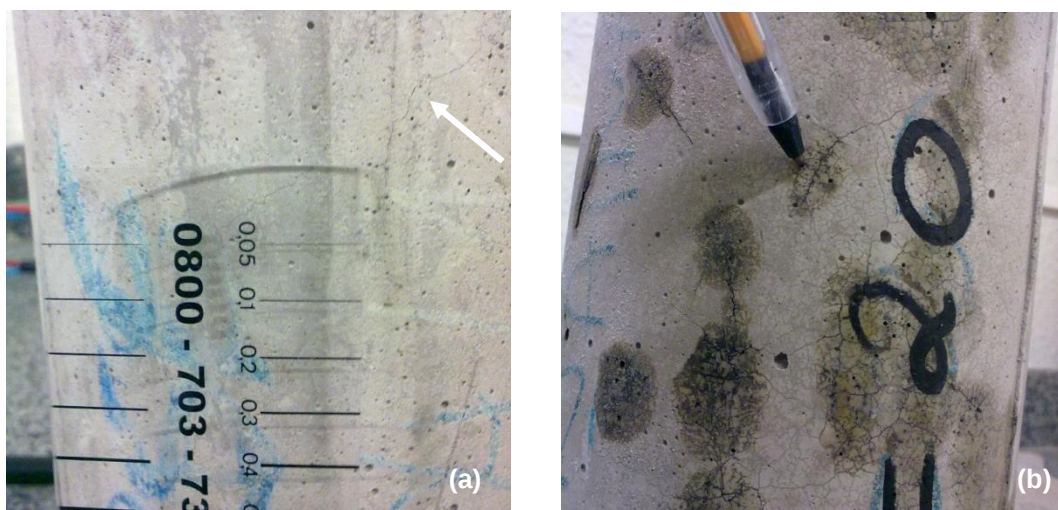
Fissuras nos corpos de prova após aquecimento de 400 °C: (a) tipo II SF; (b) tipo I CF.
